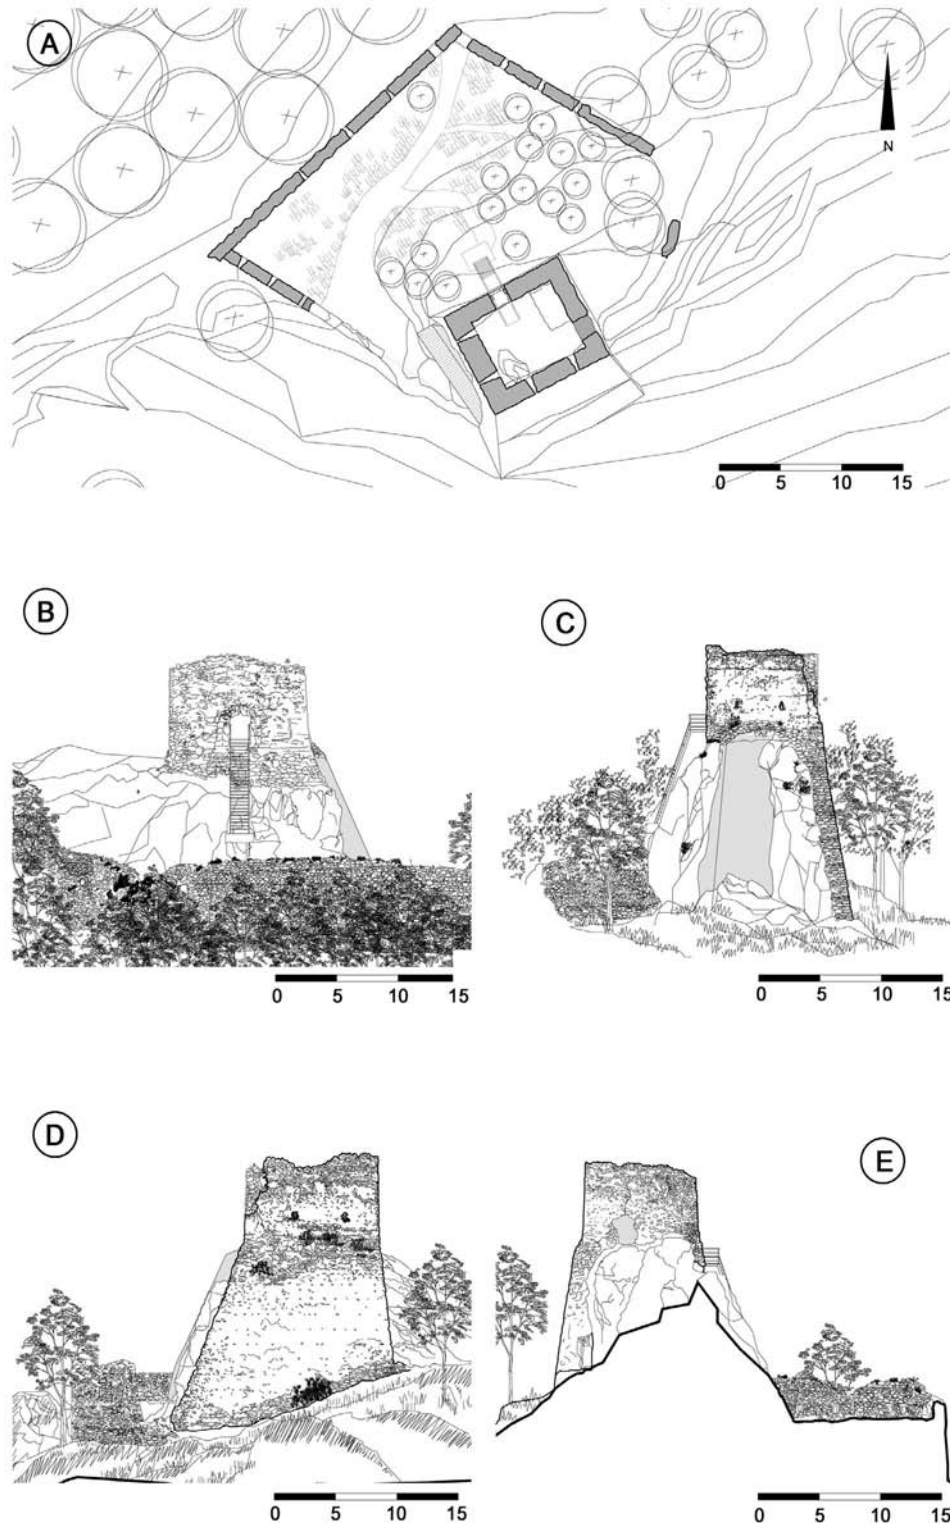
Castillo de Benifallim, estado actual. A: Planta. B: Alzado noroeste. C: Alzado suroeste. D: Alzado sureste, E: Alzado noreste.
